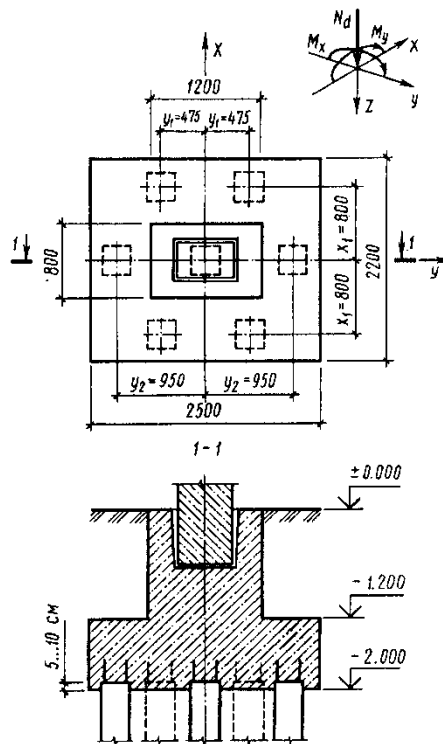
Внецентренно нагруженный свайный фундамент
